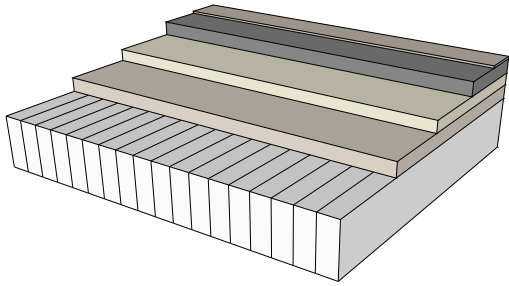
Konstruktionsschema Brettstapelholzdecke
